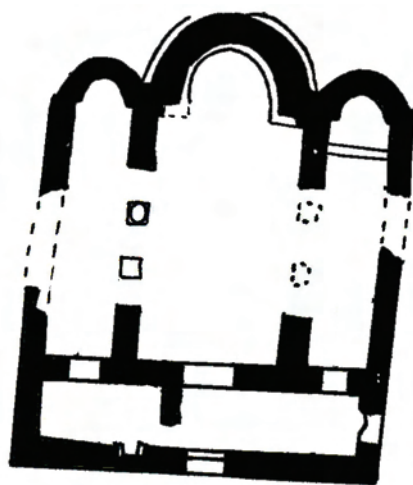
План трехапсидного храма с триболонами первого строительного периода
